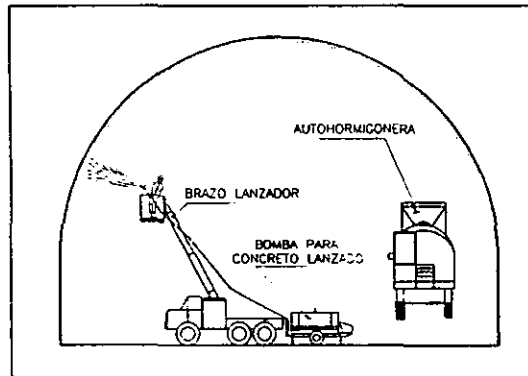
Aplicación del concreto lanzado vía húmeda.
